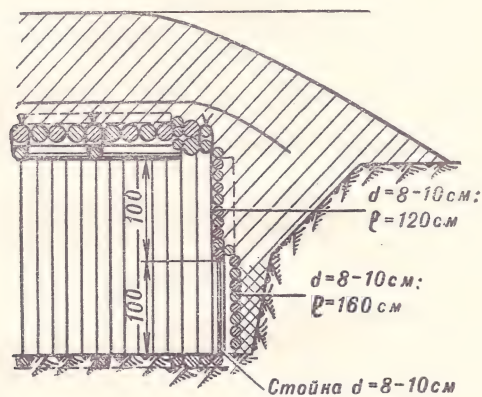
Аварийный выход в убежищах из круглого леса (после выдергивания стоек верхняя часть стены обрушивается, грунт убирается внутрь)
